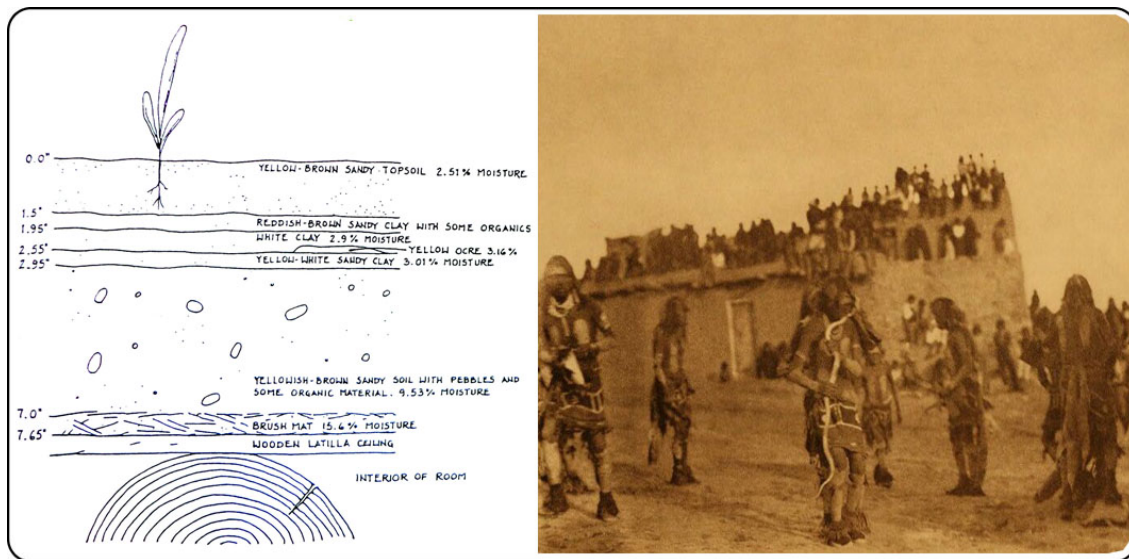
Detalle constructivo de una cubierta tipo y uso de cubierta como grada.
